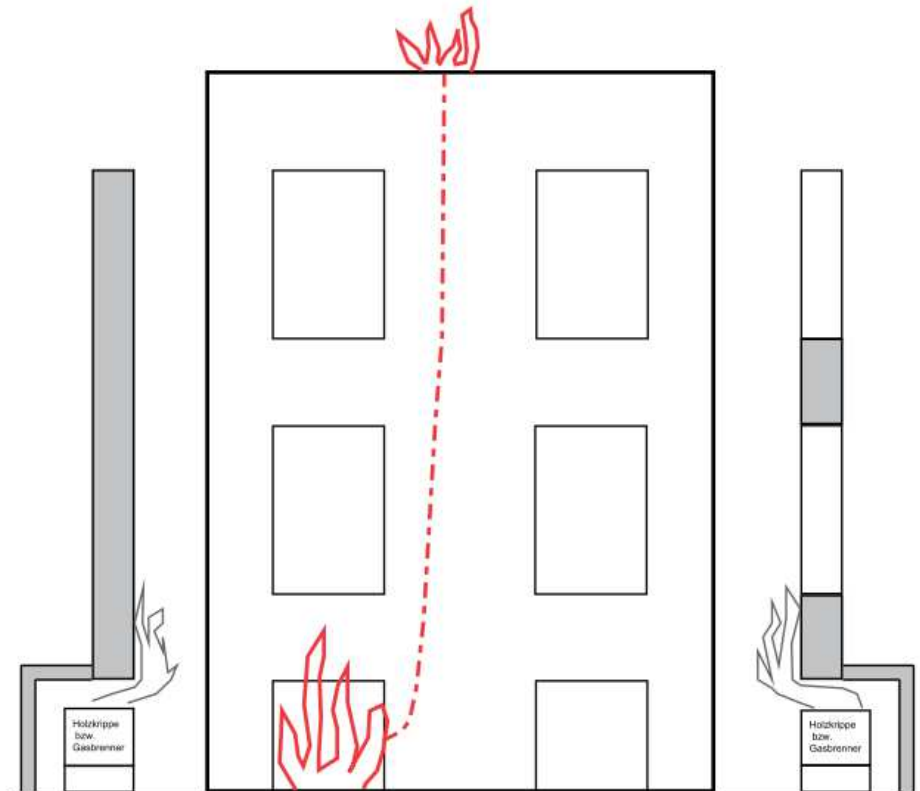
Darstellung Lochfassade mit Prüfstand und angelehnten Prüfstand
